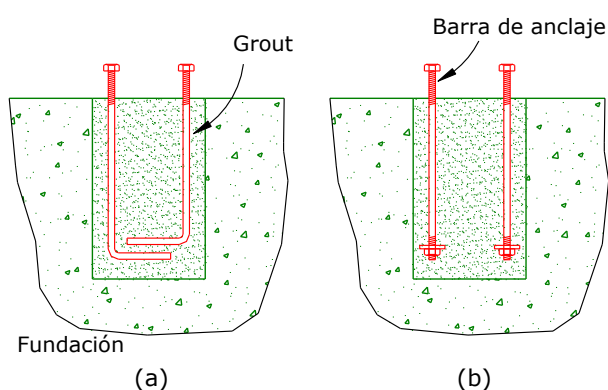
Ejemplos de barras de anclajes colocadas luego del hormigonado de las fundaciones, (a) barra con ganchos y (b) barra con tuercas en el extremo inferior.
